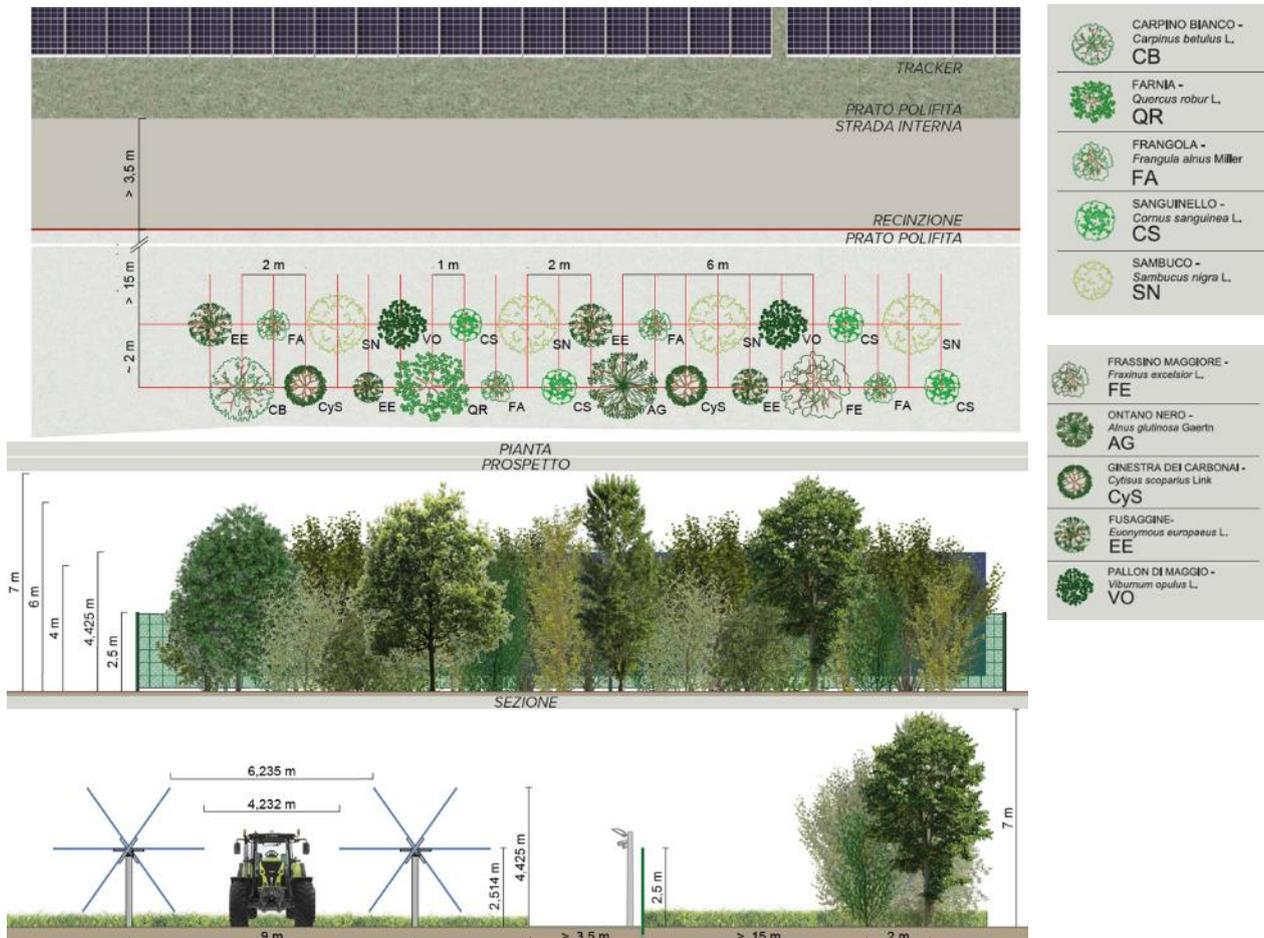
Il sesto d'impianto delle fasce di mitigazione a doppio filare di Tipo 3
